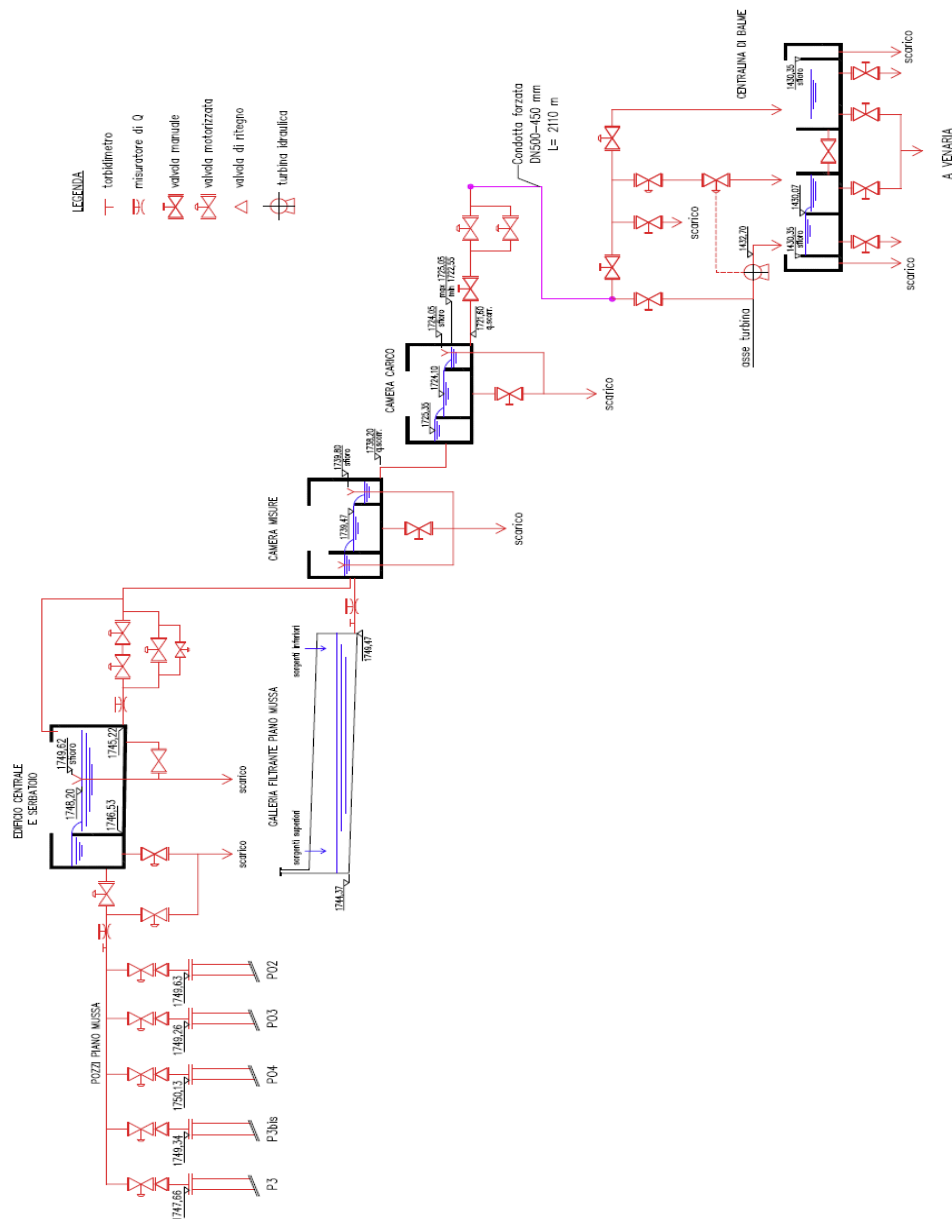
Schema funzionale di dettaglio dell'impianto Piano della Mussa a Balme
